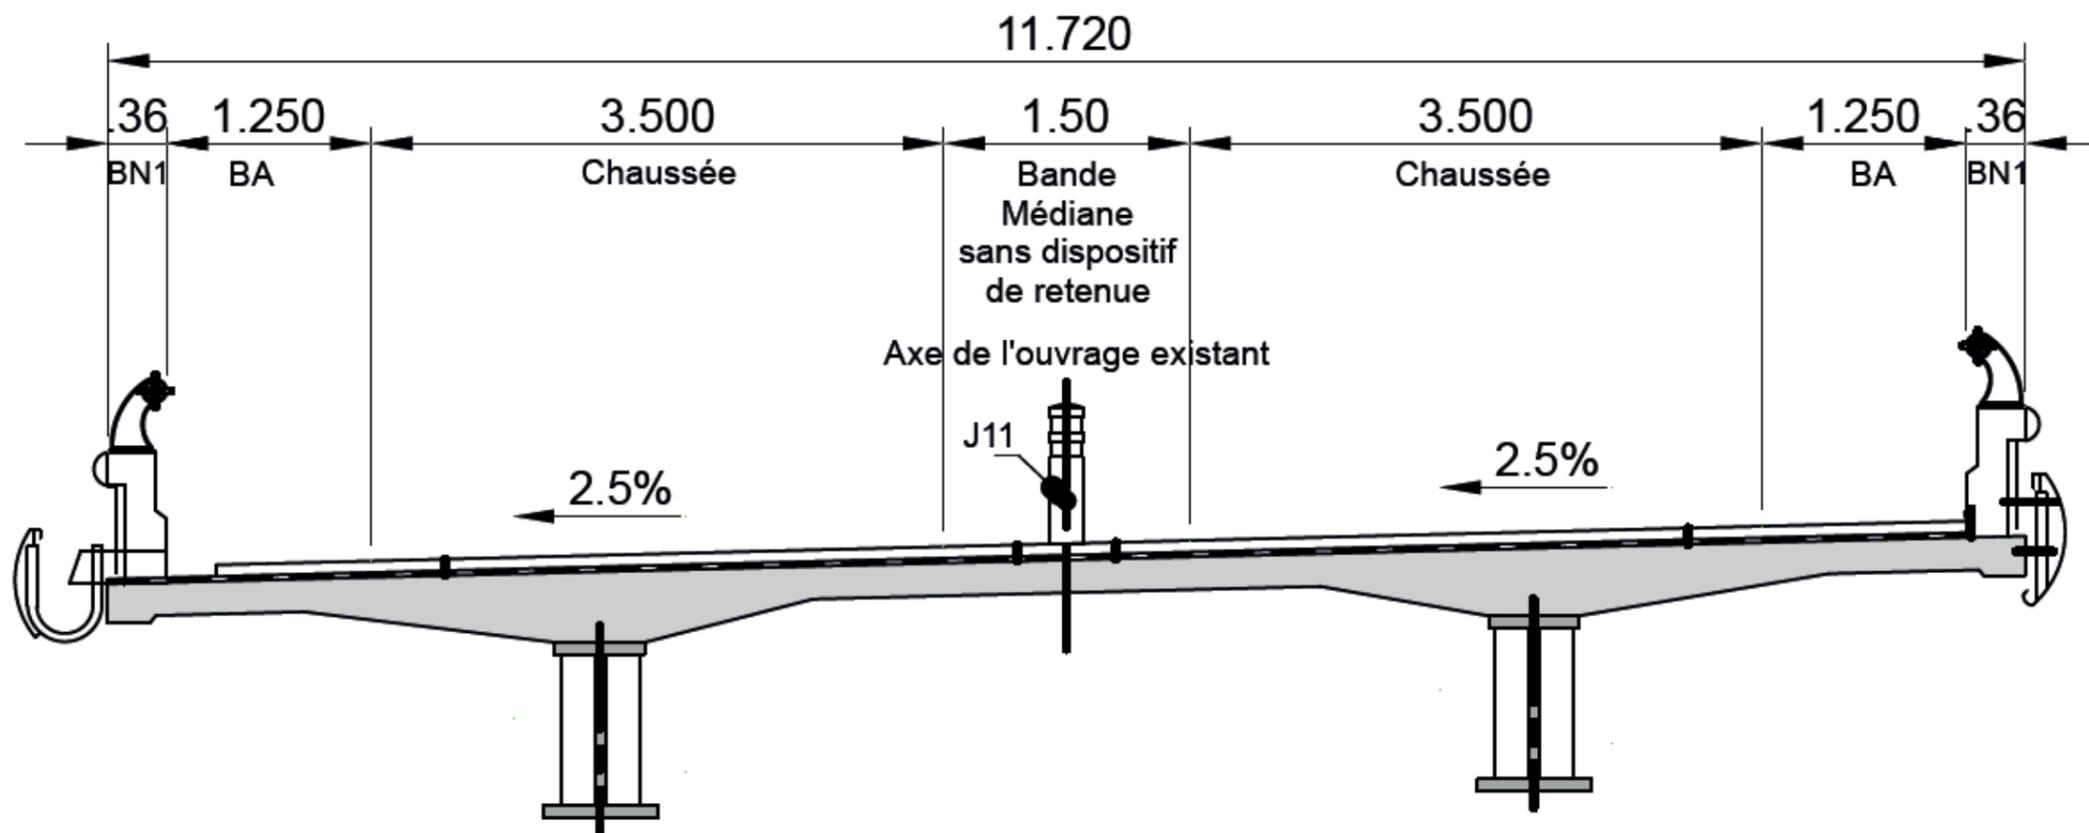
Variante 1 – Coupe sur ouvrage (source CEREMA)
